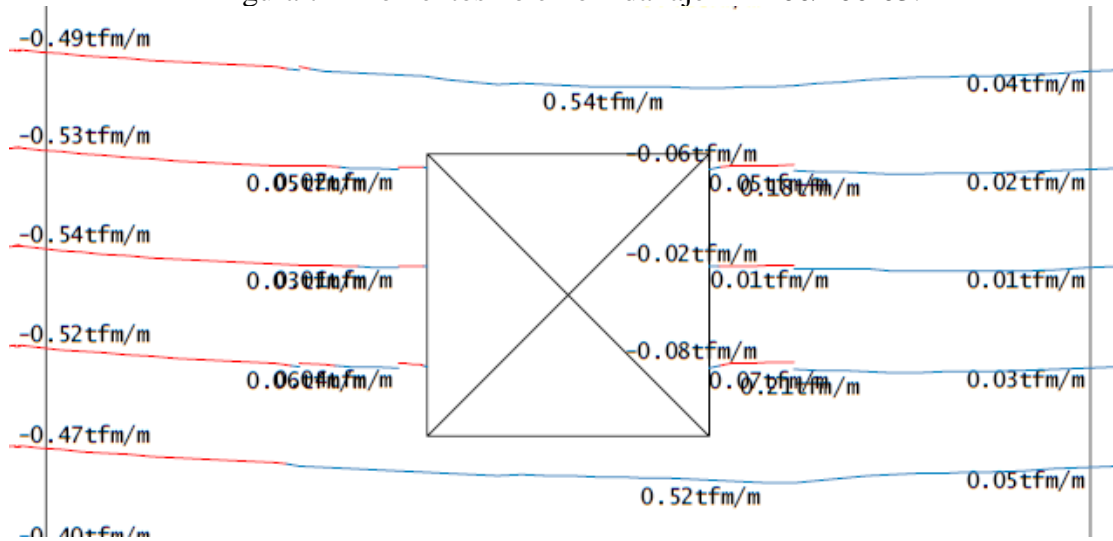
Armaduras negativas horizontais e verticais para a laje LA 100/100-03.
